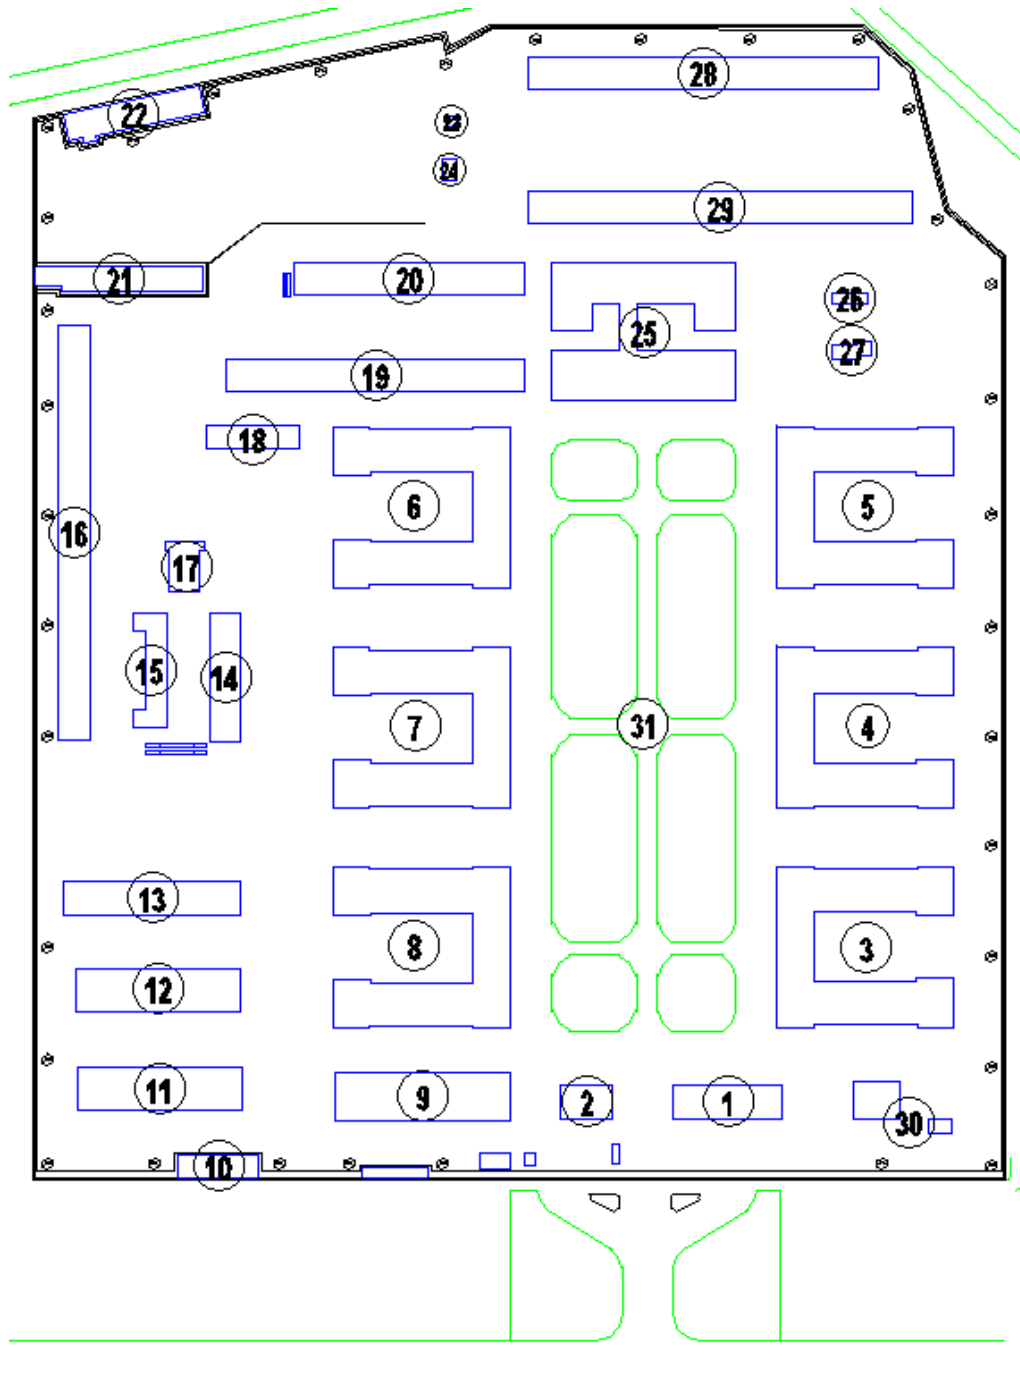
Planimetria della Caserma Cavarzerani di Udine.
